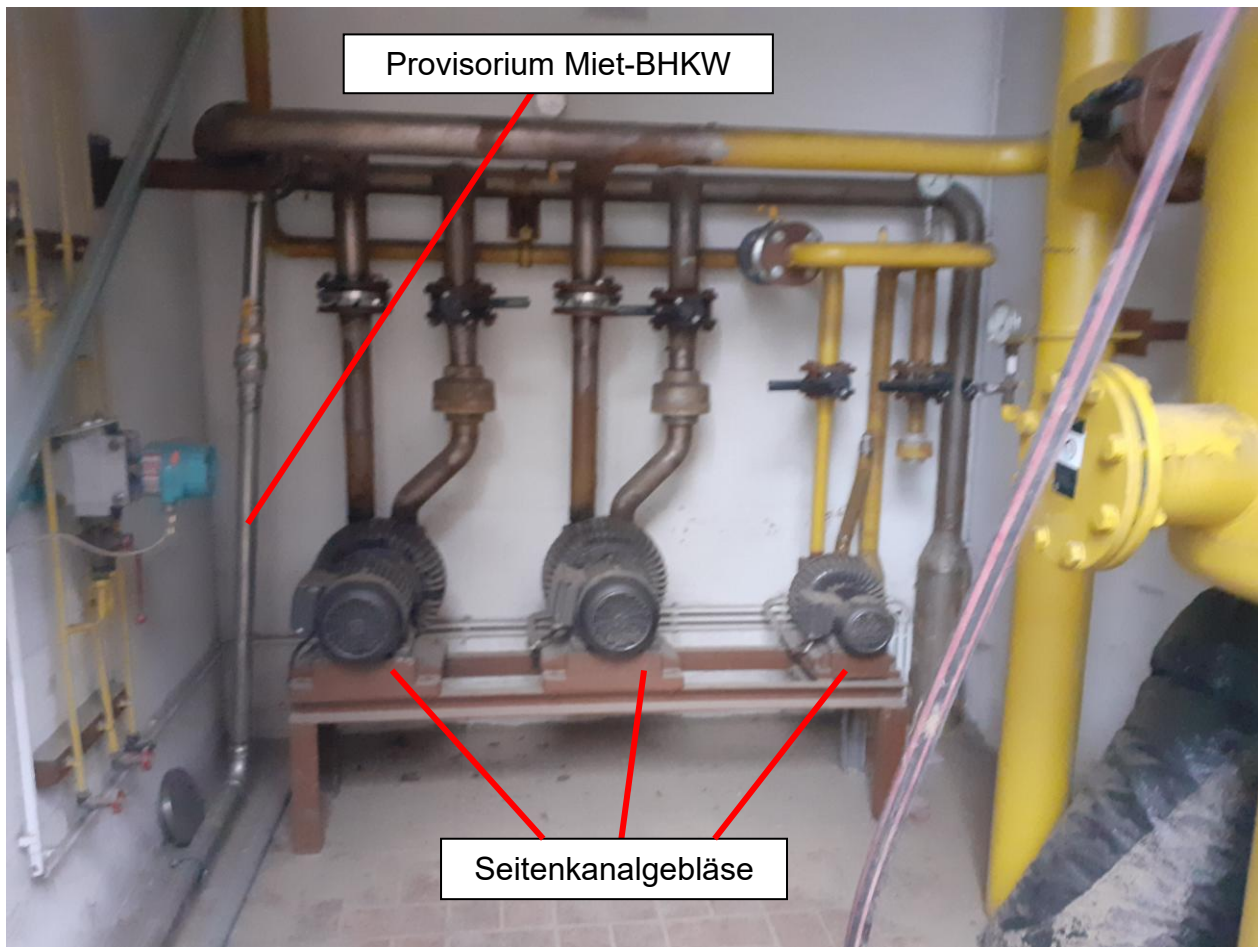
Seitenkanalgebläse und Bestandsverrohrung im Gasmessraum
